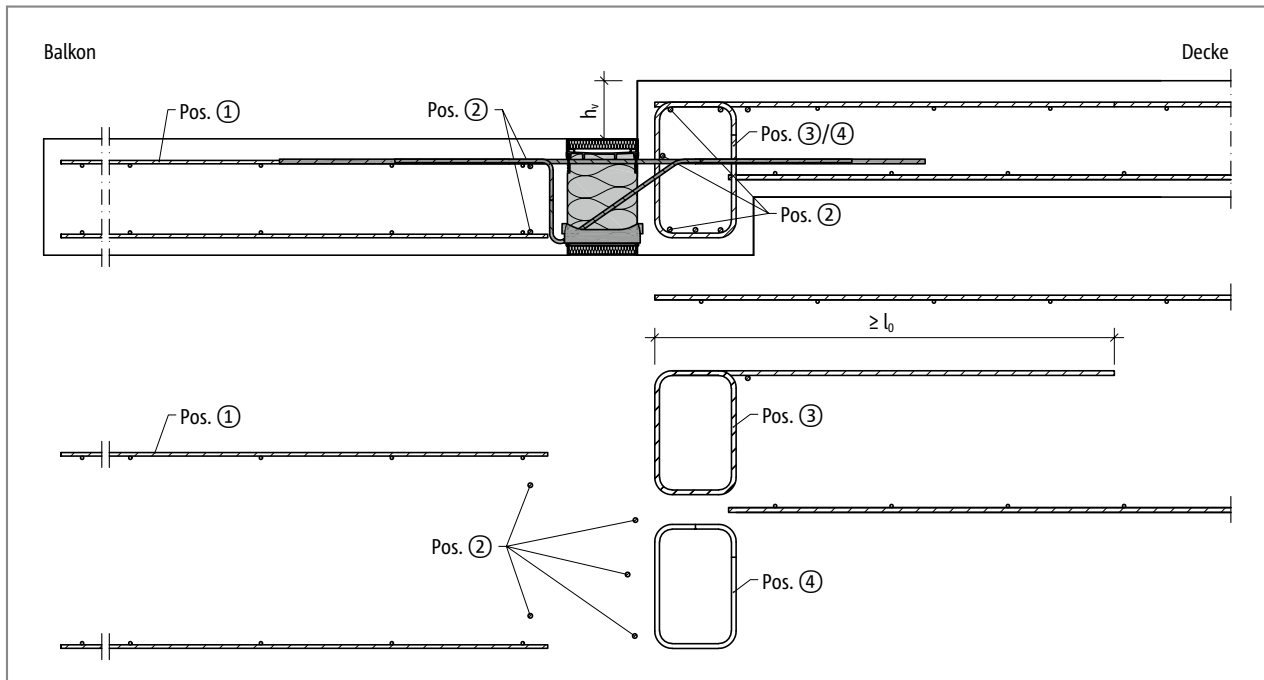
Schöck Isokorb® XT Typ KL: Bauseitige Armierung für kleinen Höhenversatz
